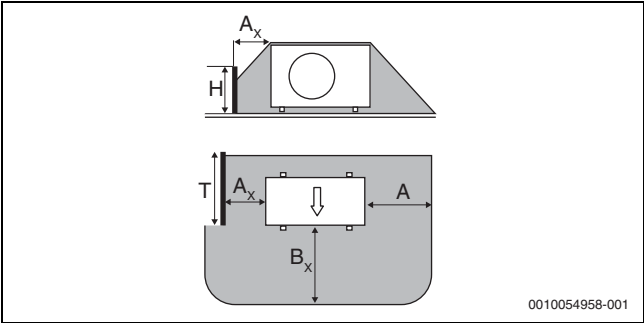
Schutzbereich mit Barriere links, bodenstehende Wärmepumpe
